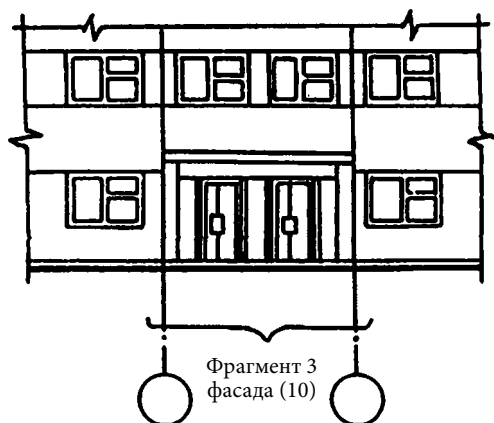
Обозначение фрагментов планов, разрезов, фасадов
